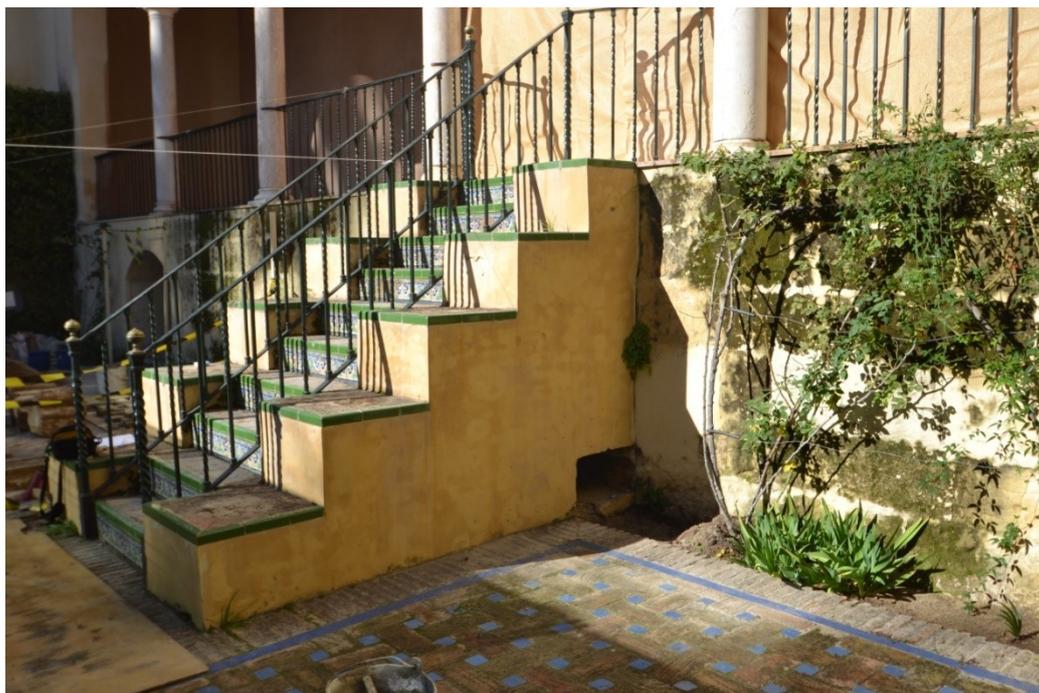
Apertura de zanja de ventilación bajo la escalera que da acceso a la Galería del Jardín de Troya.
